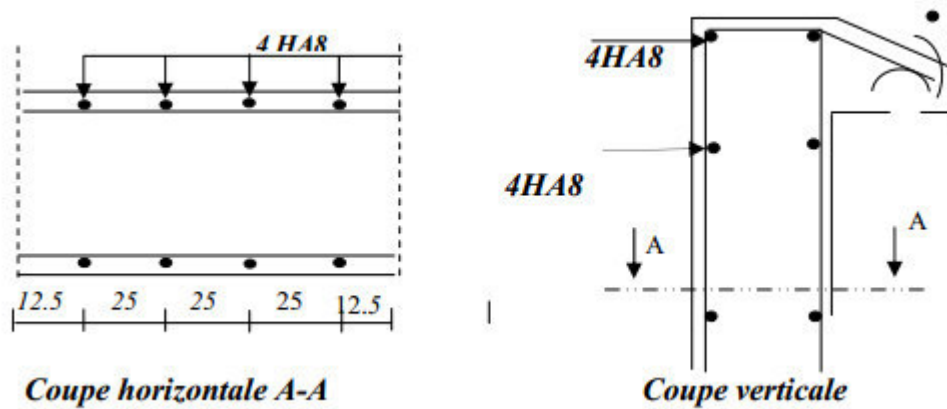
Schéma de ferrailage de l'acrotère.
